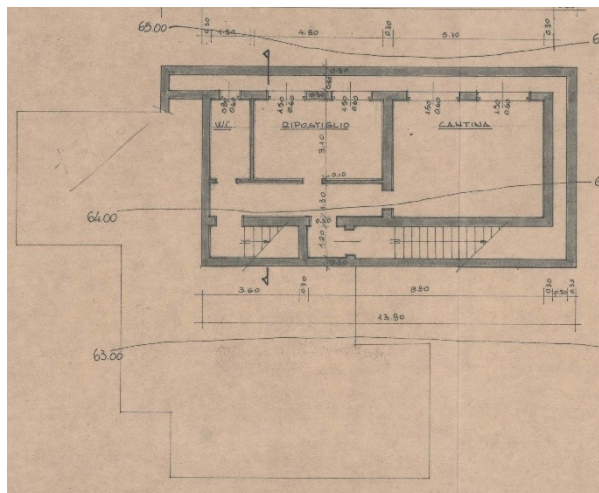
Stralcio C.E. 1147/89 – Piano interrato
